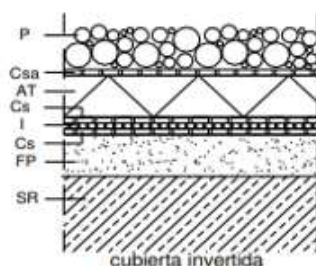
Cubierta plana, no transitable, sin cámara, invertida y con capa de protección de grava. Fuente CTE CEC.
